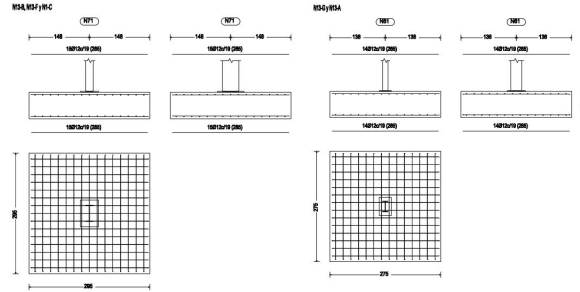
Zapata tipo A (izquierda), Zapata tipo B (derecha)
